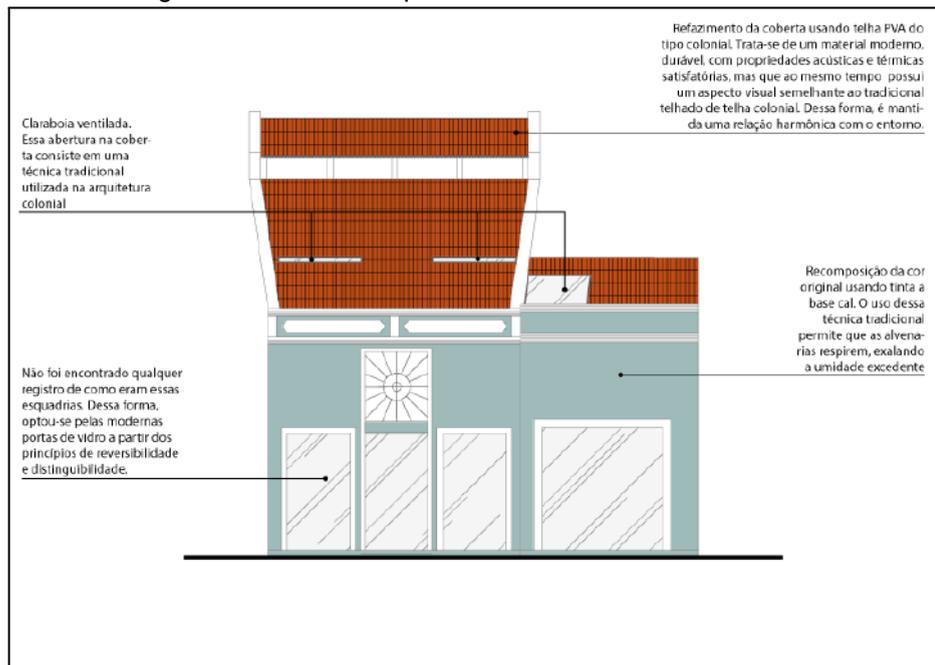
Materiais aplicados na fachada da Praça Dom Vital
